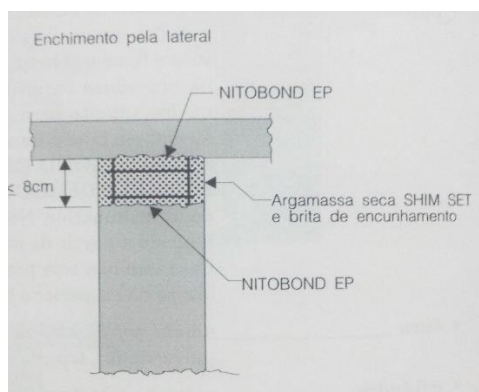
Detalhe da concretagem do topo do pilar (Helene, 1992)
